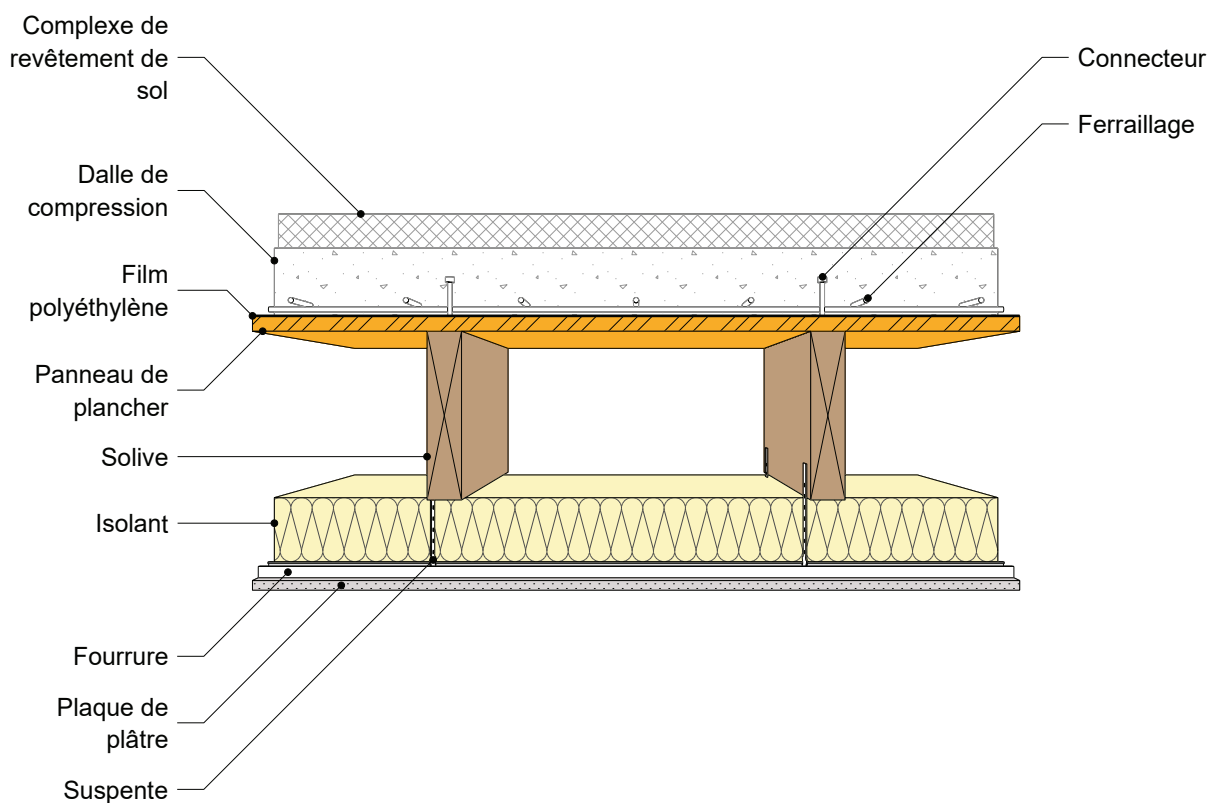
Plancher mixte bois-béton sur solivage en bois massif selon Recommandations Professionnelles RAGE 2012 et/ou Avis Techniques / DTA
